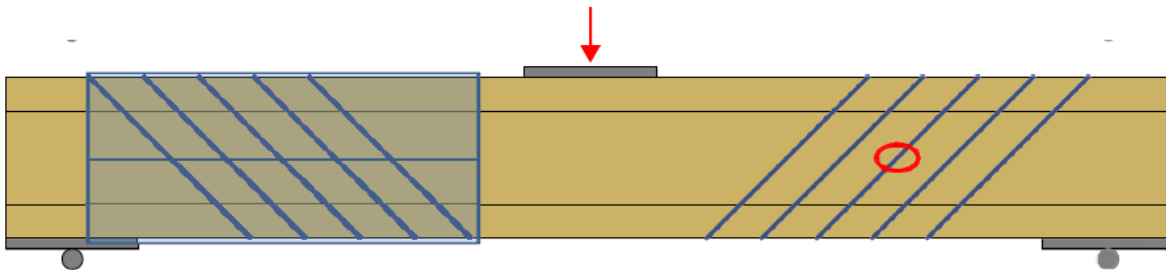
Schéma de principe d'une poutre renforcée au cisaillement en utilisant des vis ; la zone marquée est la zone renforcée.
